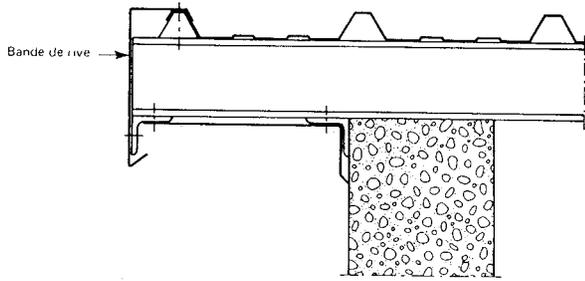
Rive - Raccordement d'une couverture avec un mur par une bande de rive et un profil d'habillage de la sous-face - Coupe verticale
